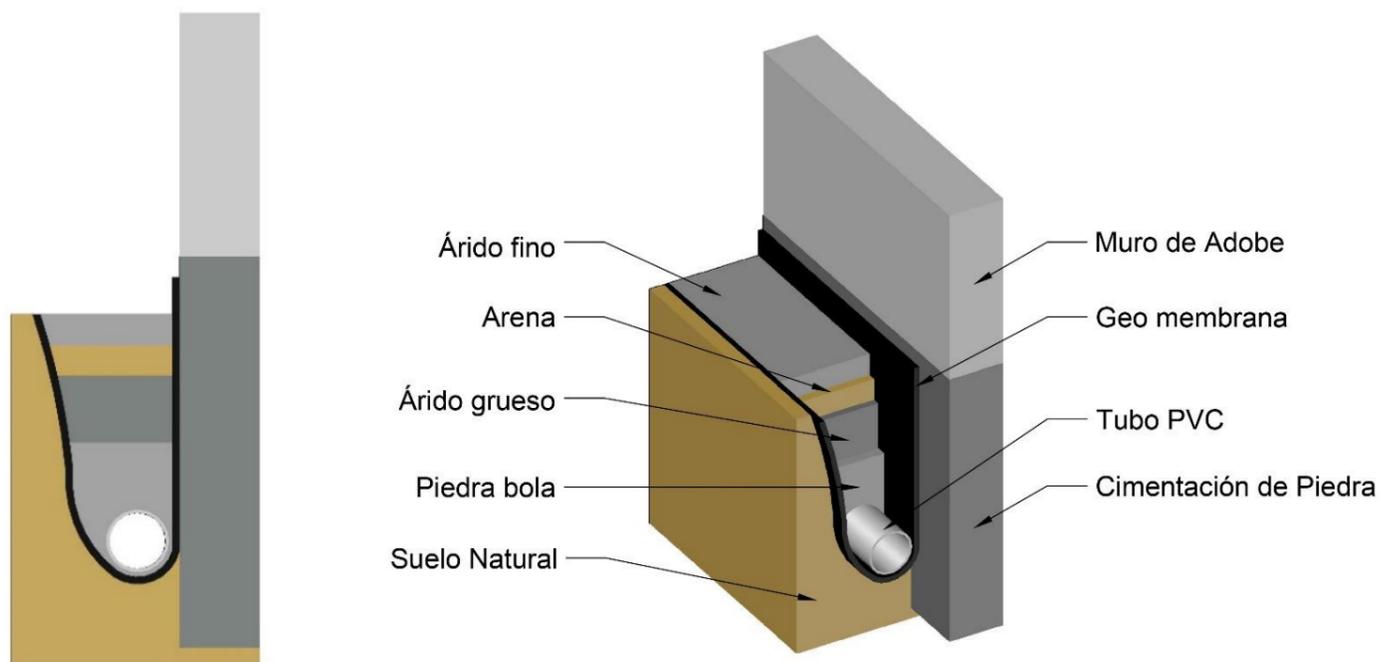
Detalle de tubería para drenaje. Fuente Luis Segovia 2023
